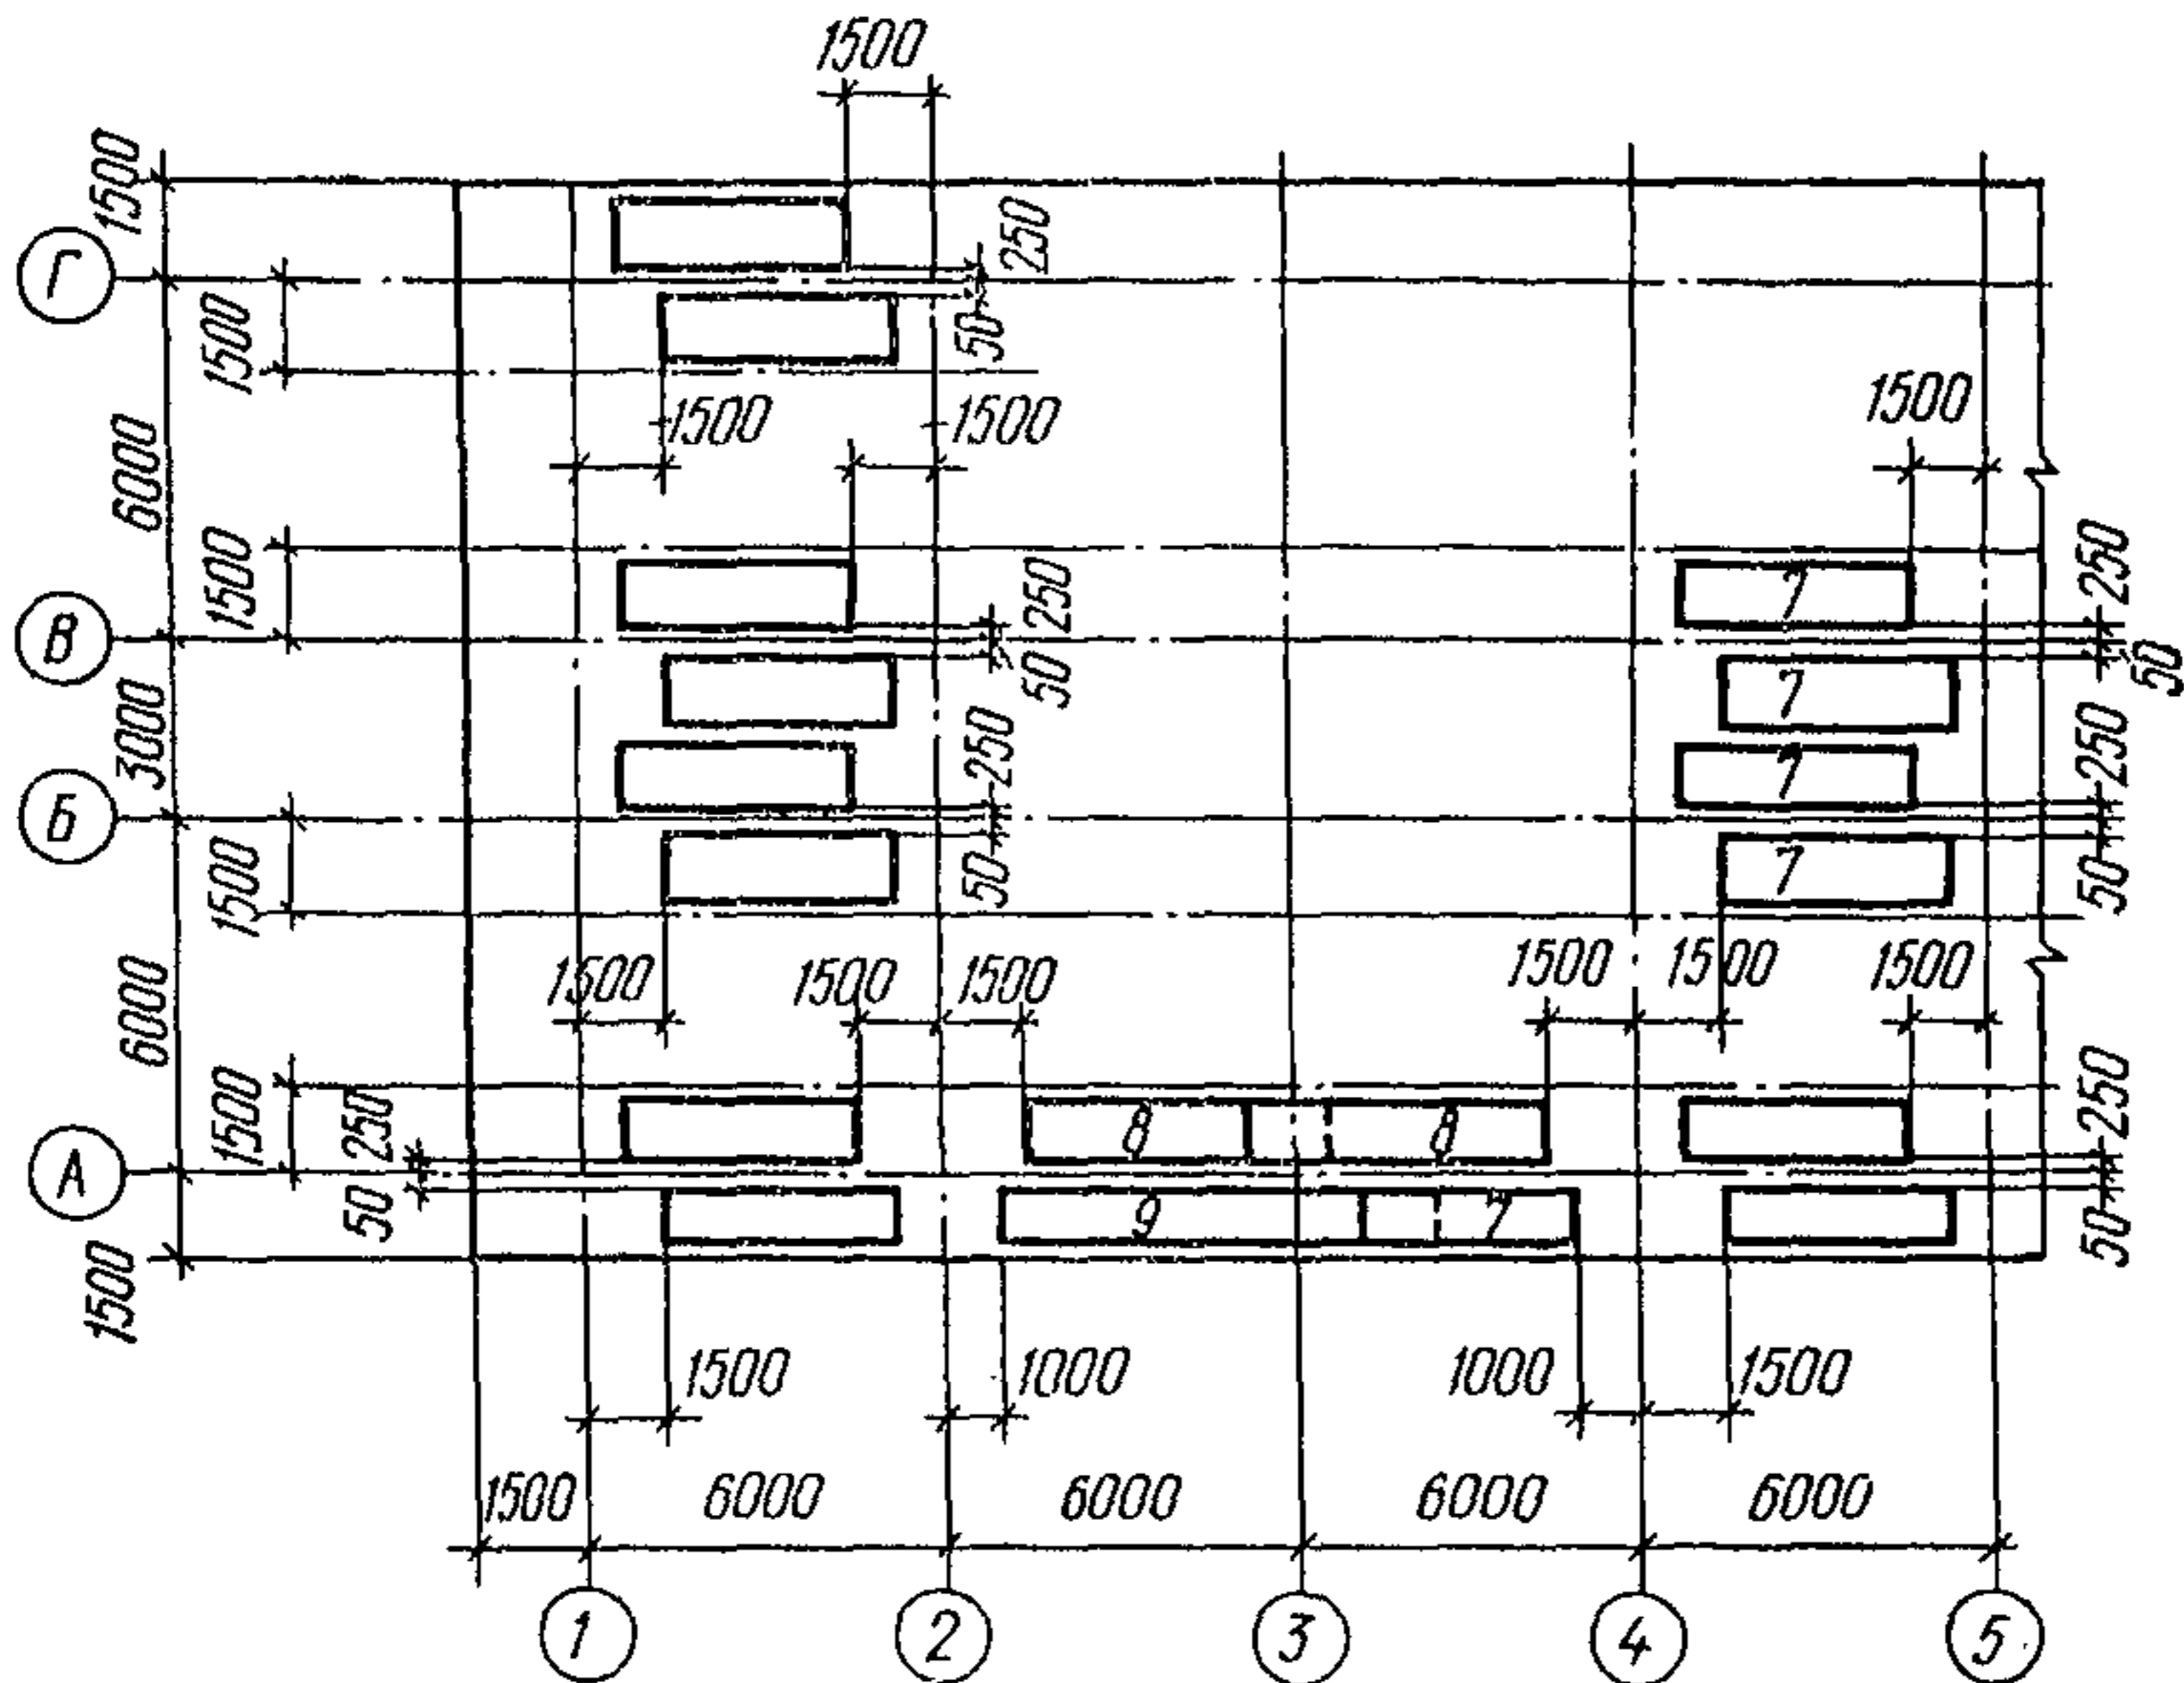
План раскладки в продольном направлении плиты унифицированных сеток третьего слоя нижней зоны
